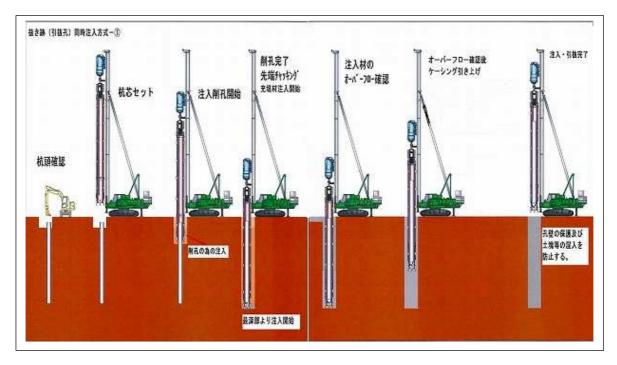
杭先端パワーチャッキング (PG) 工法 (同時注入方式) ・施工順序
